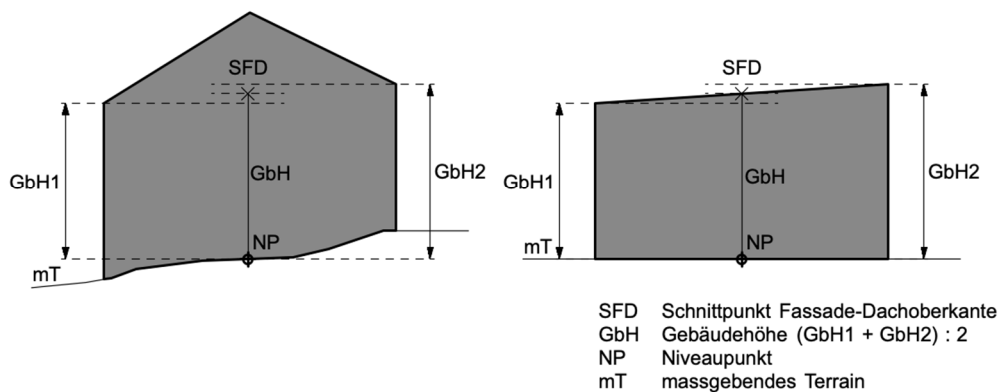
Unterschiedlich hohe Traufen: Ausgemittelter Schnittpunkt „Fassade-Dachoberkante“
